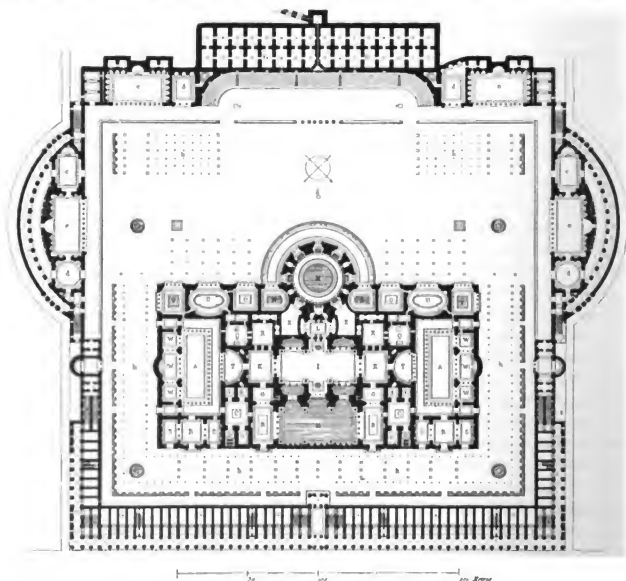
Thermae des Garsulla. Restaurirter Grundriss.
